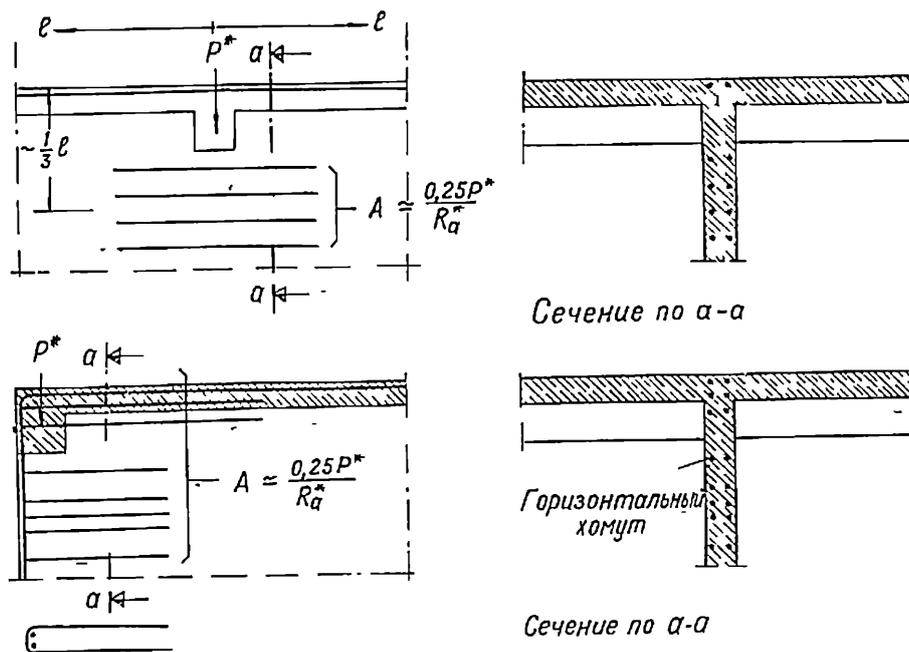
2. Поперечное армирование стенок в зоне приложения опорных давлений балок
